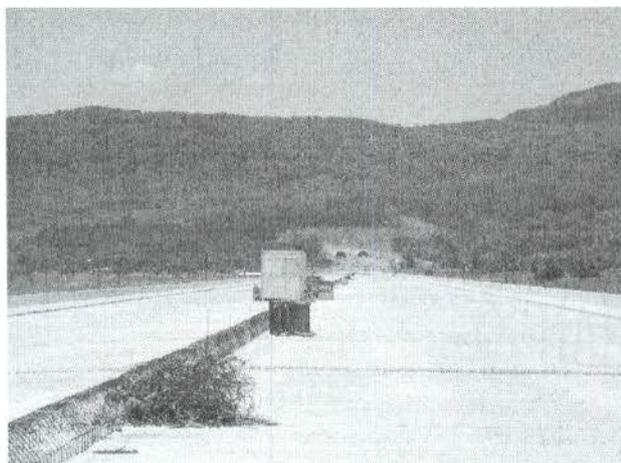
Elevado da Várzea do Maquine. Ao fundo, Emboque Norte do Morro Alto
